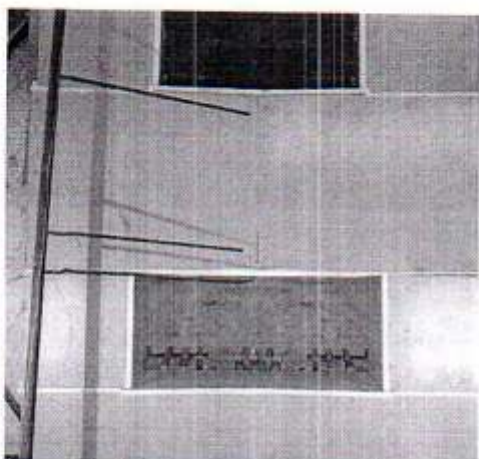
Б. Фрагменты образца фасада до испытания по ГОСТ 31251-2008.
